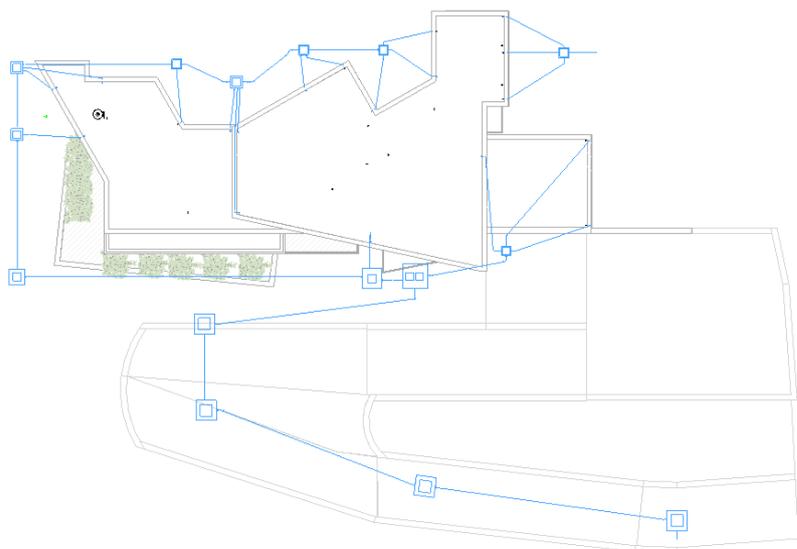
Planta da rede de drenagem de águas pluviais
